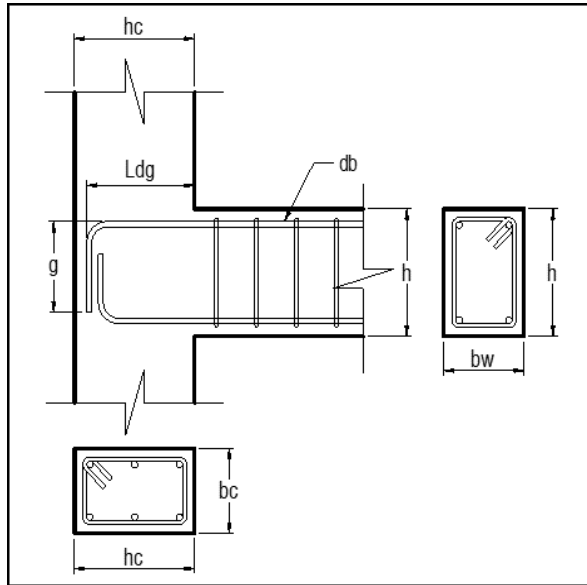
Unión Viga Columna. Fuente: Elaboración propia.
